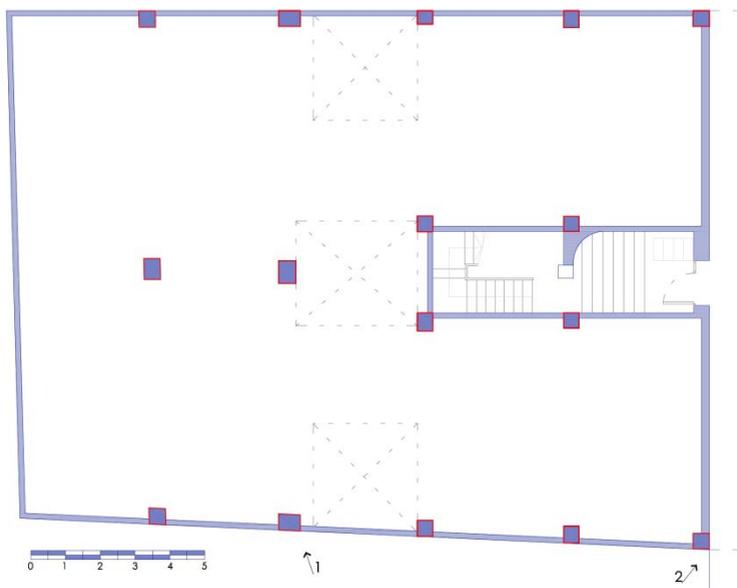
, plano de Planta baja, indicando la situación de las fotografías de la Imagen 4
